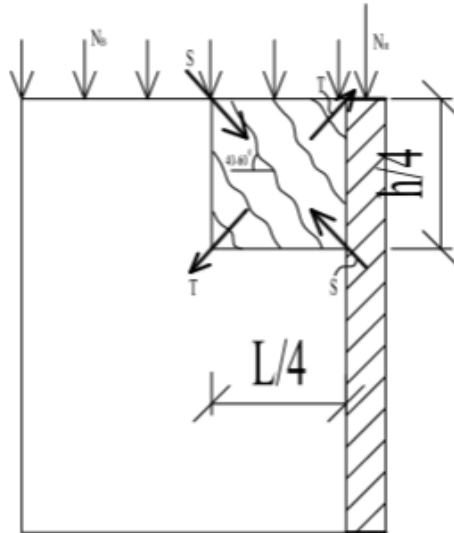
Схема образования трещин и общий вид разрушения стыка
